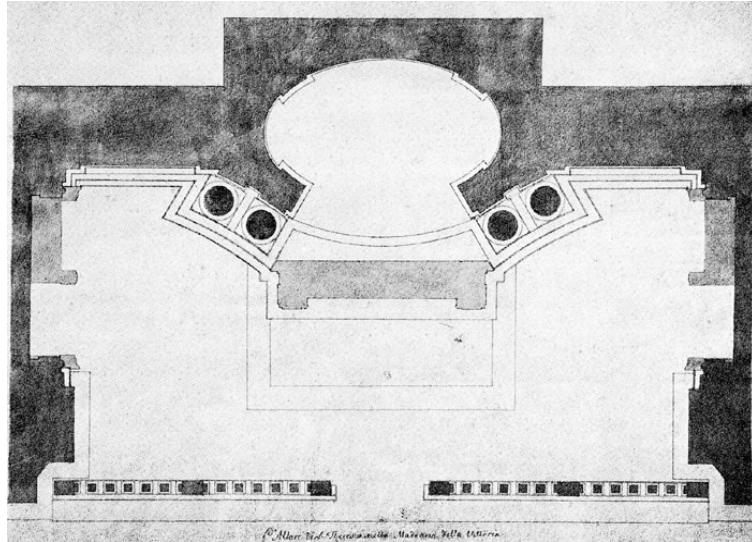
Grundriss der Kapelle Cornaro (Detail), aus:
